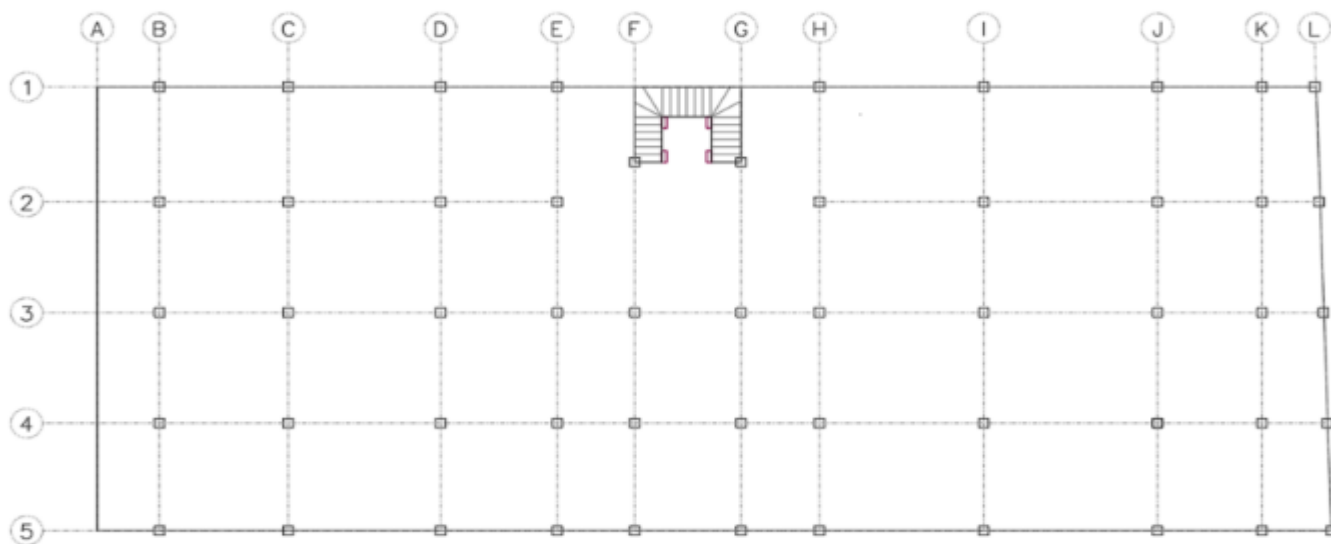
Planta arquitectónica de 4 niveles proporcionado por Andrés Pulido, representante de VigaTec
